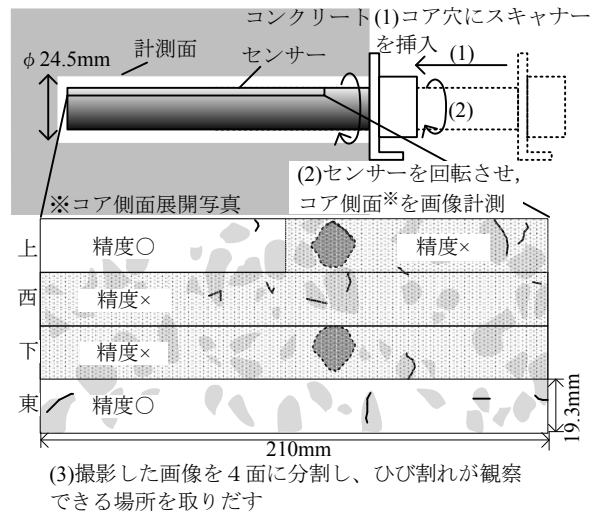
小径コア (φ24.5mm) ひび割れ撮影
